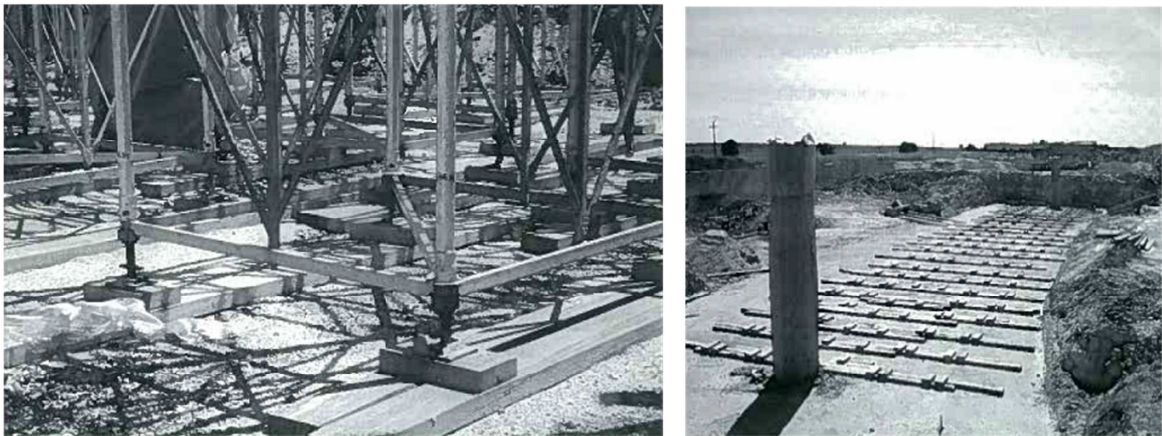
Cimbra Apoiado em Tábuas de Madeira [3].
